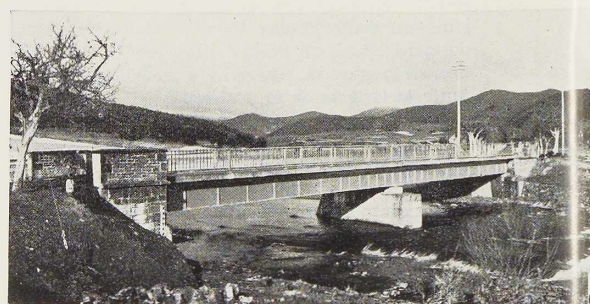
Pont soudé sur la Lahn à Eckelshausen.
